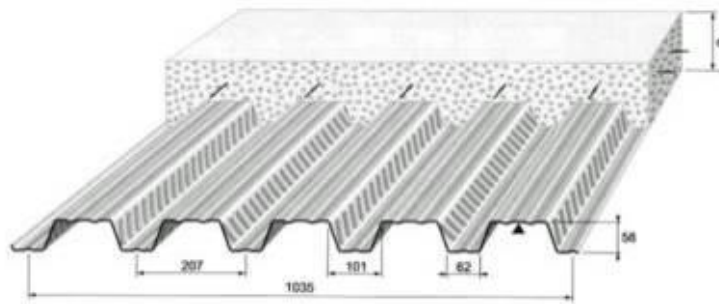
Сталезалізобетонне перекриття по профнастилу
